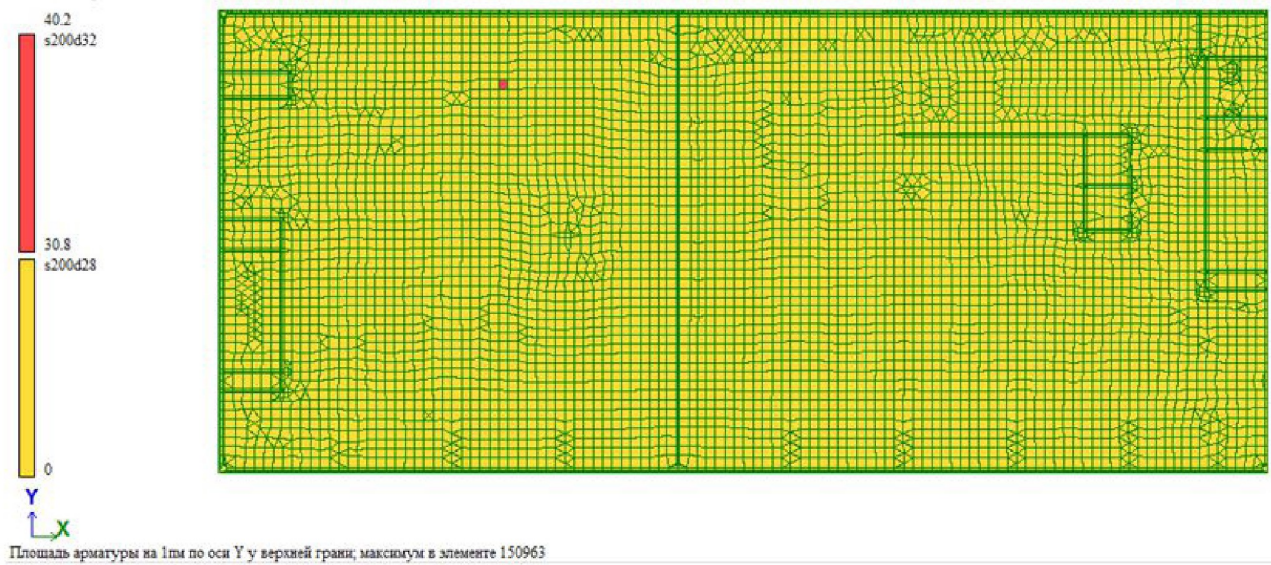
Армования фундаментной плиты (верхне по Y)
